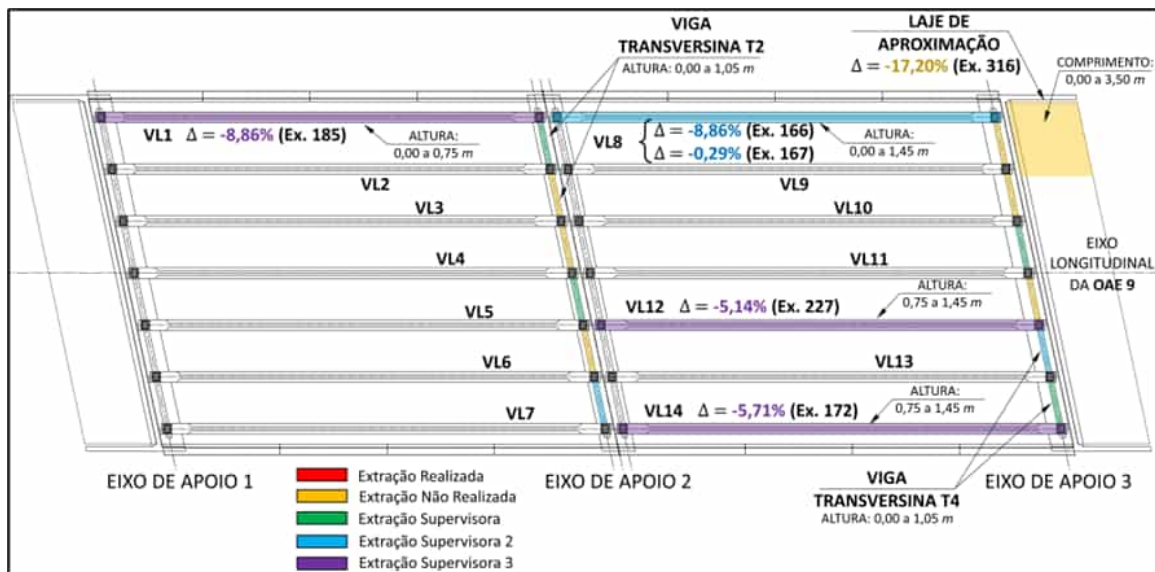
Elementos sugeridos para a “quinta” campanha.
